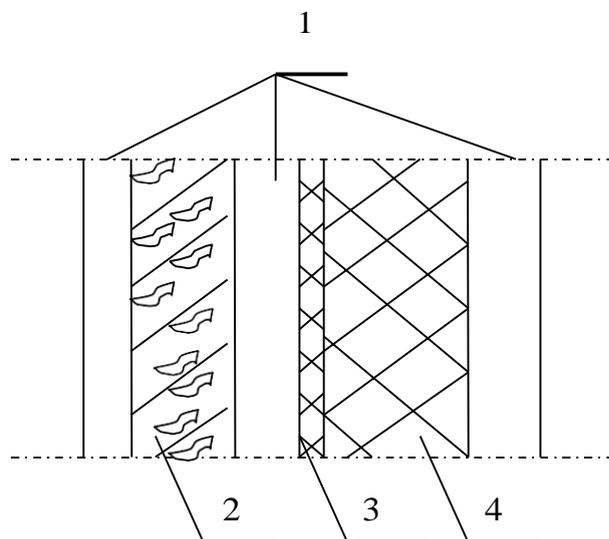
1 – штукатурка, 2 – плита железобетонная, 3 – пароизоляция, 4 – теплоизоляция.
